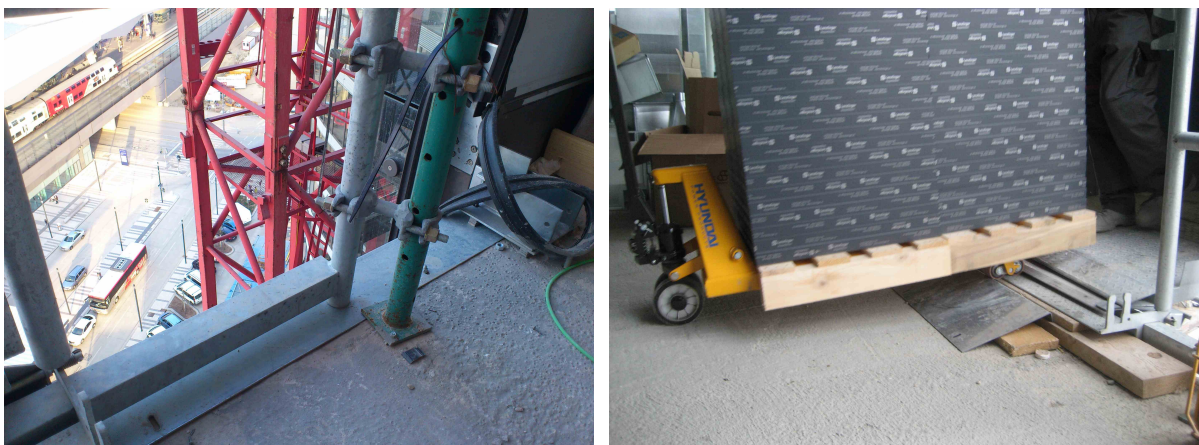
Etagenaustritt Rohbaudecke (falsche Montage)
